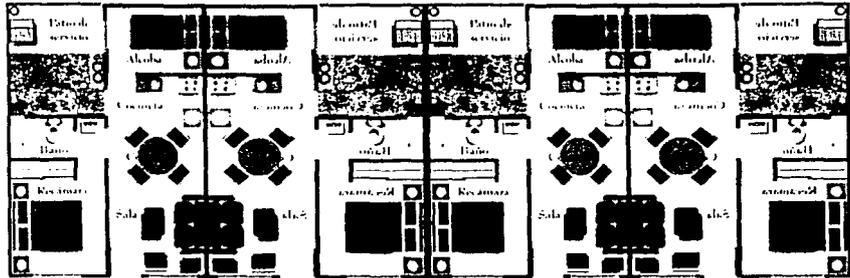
Planta baja, conjunto cuádruplex "SH-EM01".
